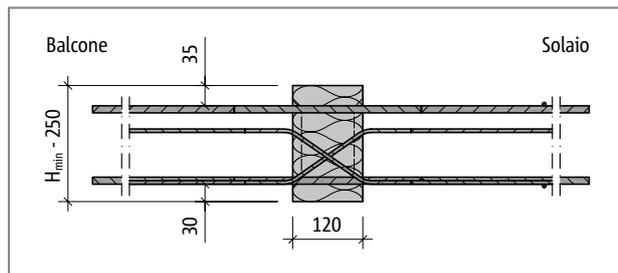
Schöck Isokorb® tipo DXT per CV35: sezione dell'elemento
